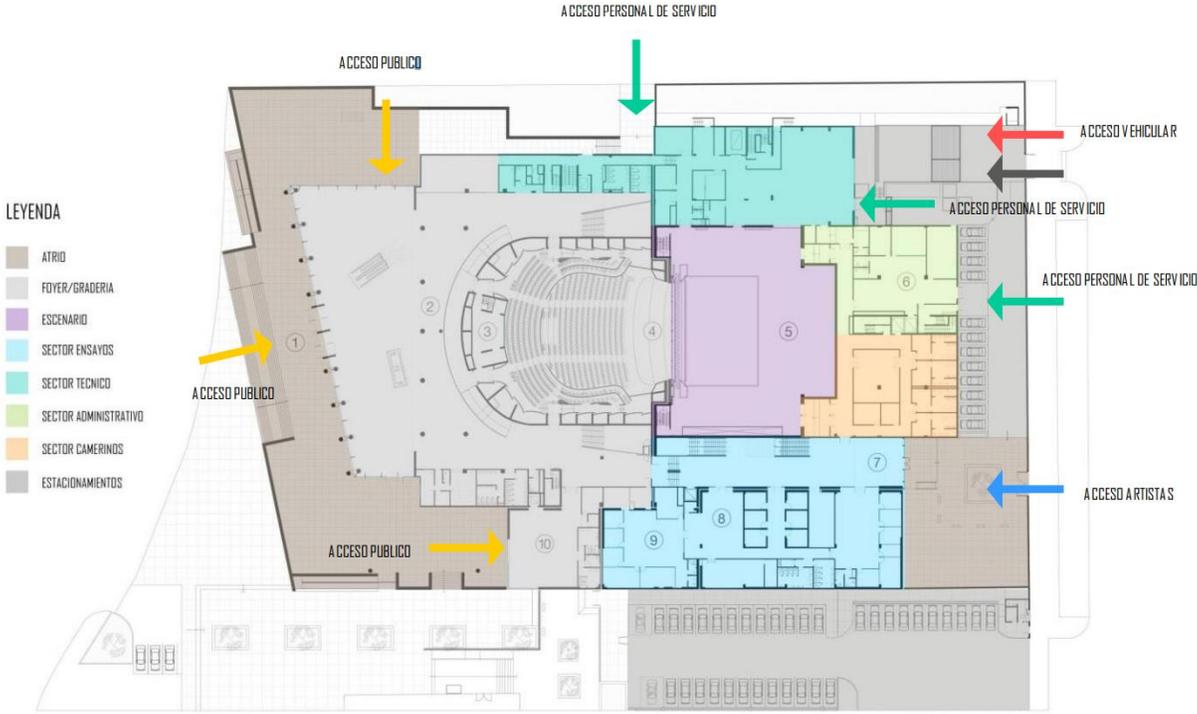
Plano de Accesos y zonificación del Gran Teatro Nacional - Planta
